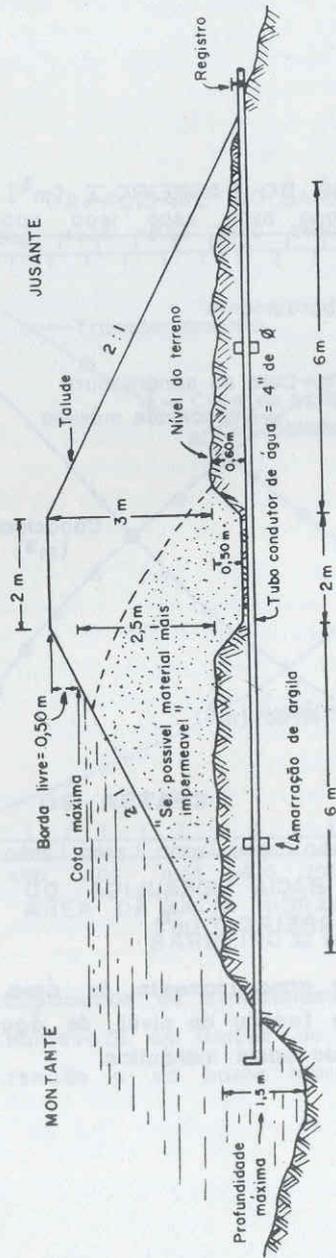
Modelo esquemático do dimensionamento da parede do barreiro e locação do tubo condutor de água.
